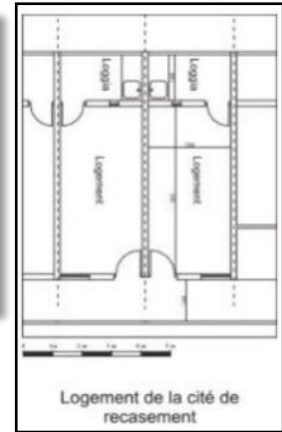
plan de logement type f1. Source (Rif, 2016)
